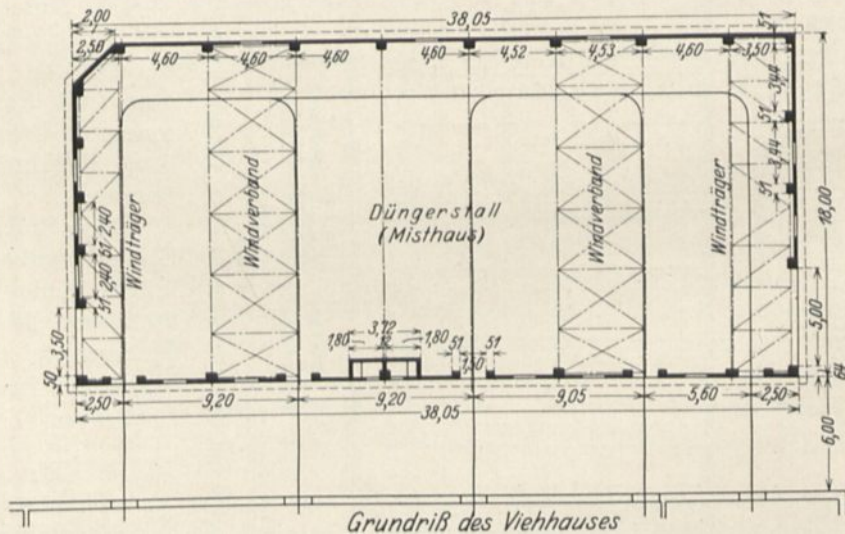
Düngerstall in Groß-Kussewitz. Grundriß. (Im Abstände von 6 m unterhalb des Düngerstalles ist der Grundriß des Viehhauses angedeutet.)
